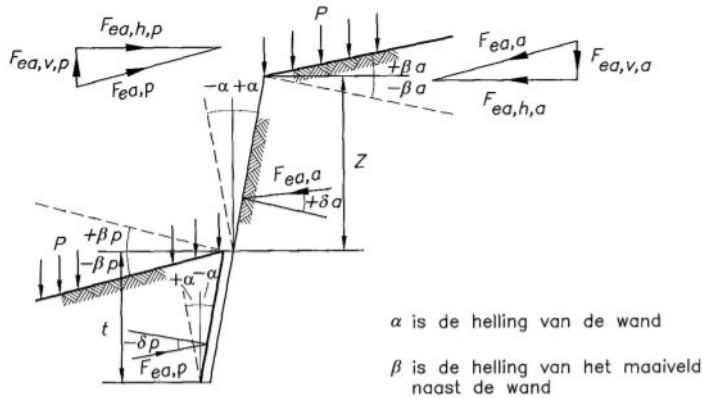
Niveaus en hellingshoeken bij een damwandberekening.
